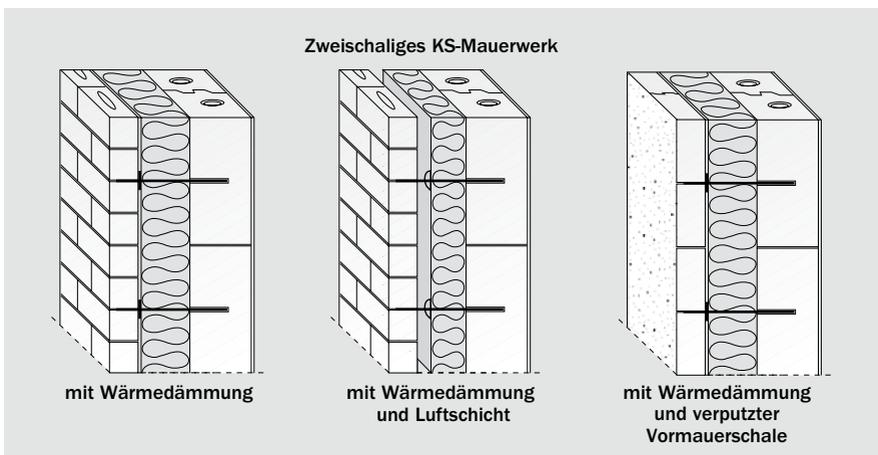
/20: Zweischalige KS-Außenwandkonstruktionen für beheizte Gebäude
